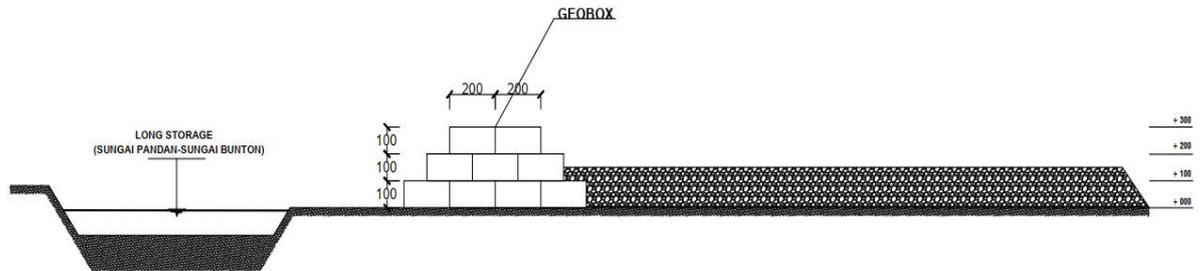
Denah Alternatif 2 (Area Tambak)
